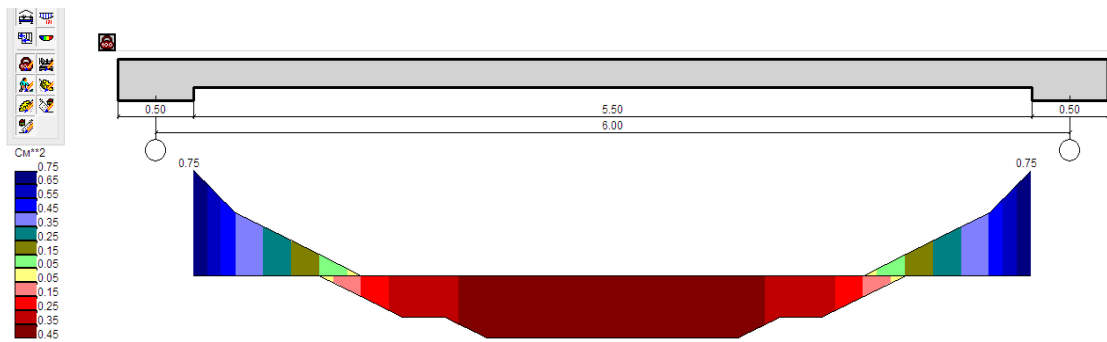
Схема підбору та розташування поздовжнього армування балки
